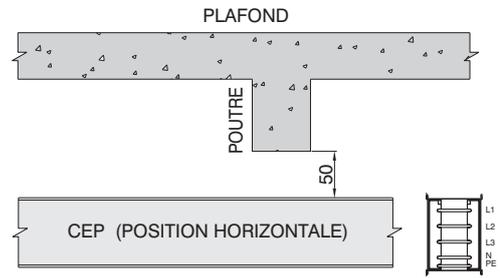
CROISEMENT D'UNE POUTRE EN POSITION HORIZONTALE
